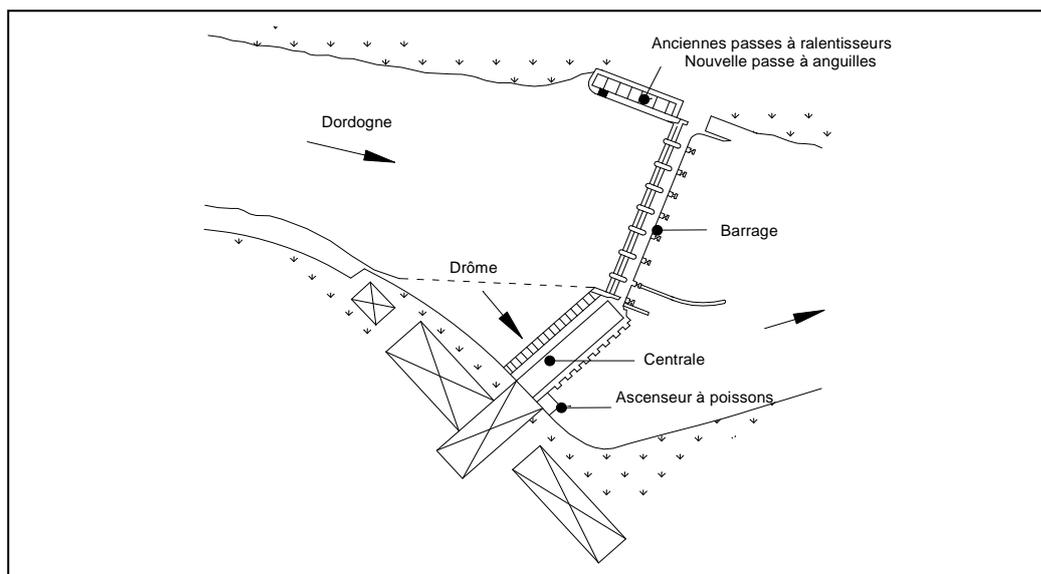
Localisation de la passe à anguilles sur le site de Tuilières
